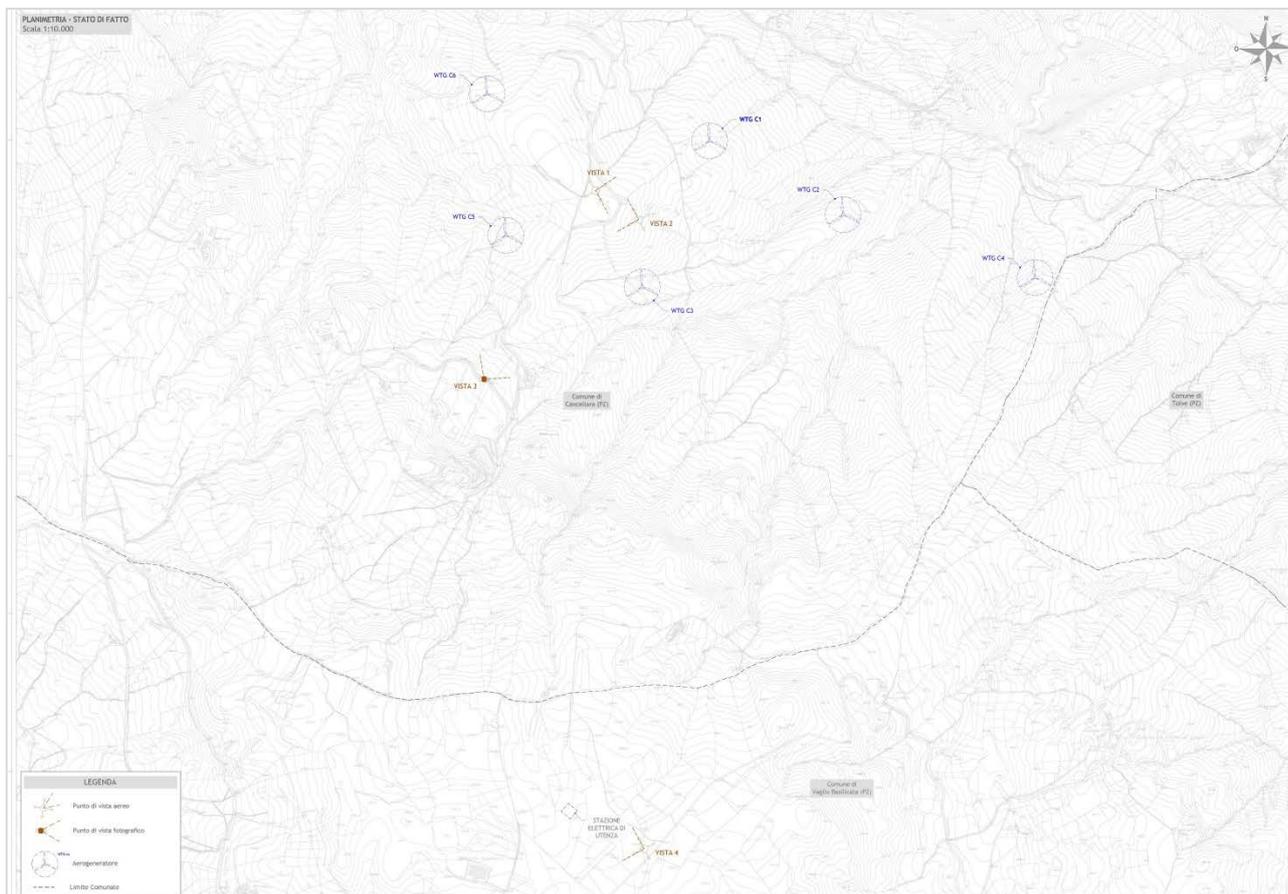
Planimetria stato di fatto, con individuazione dell'impianto eolico
